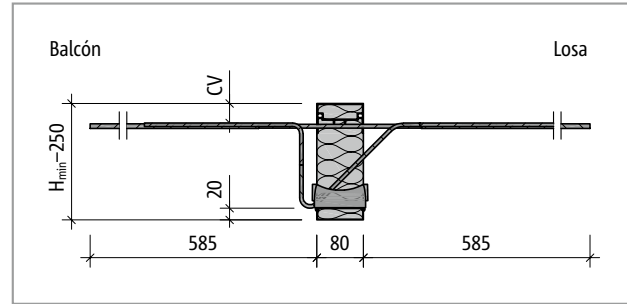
Schöck Isokorb® T tipo K-M5 y K-M6 en R0: Sección del producto
